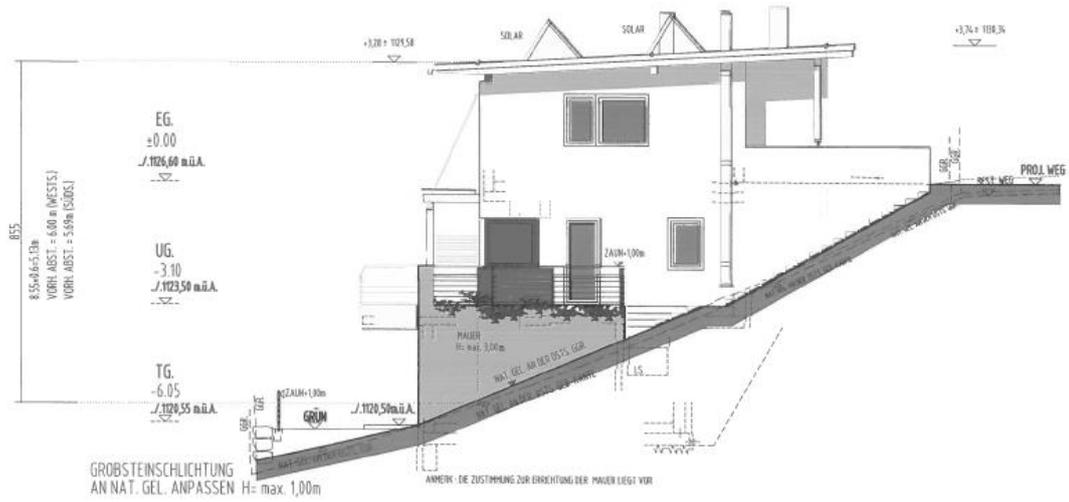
Ostansicht – Wohngebäude auf der Gp. 6142 laut Einreichplan des Planungsbüros R&S Planbau (ohne Maßstab)
